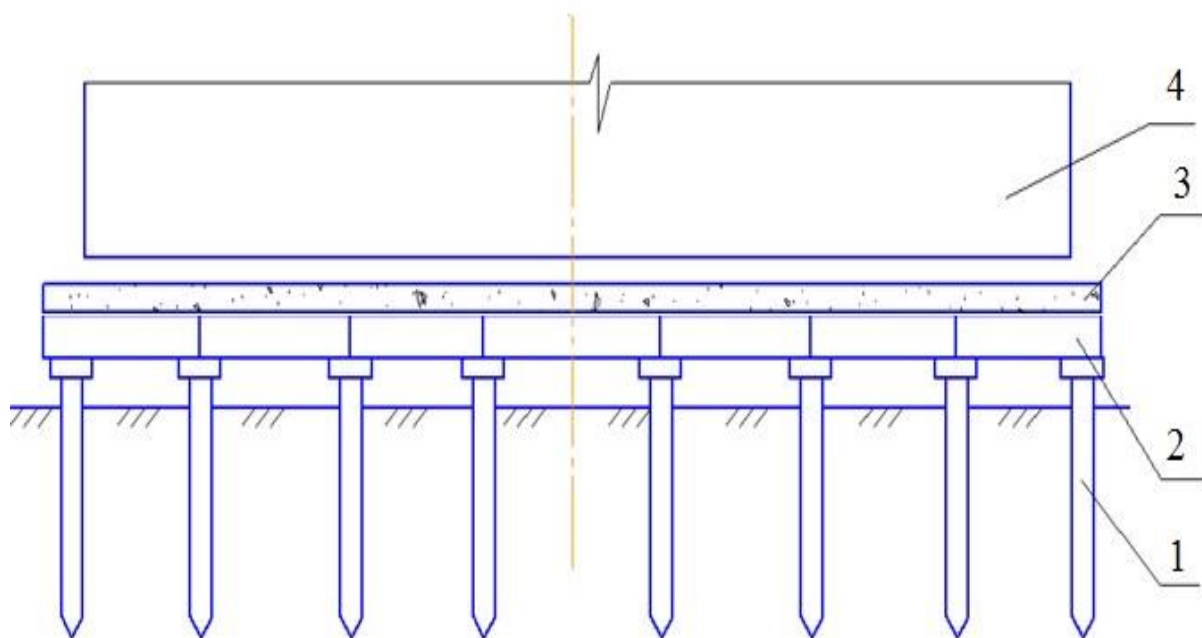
1 – сваи, 2 – железобетонные плиты, 3 – слой песка, 4 – резервуар.
